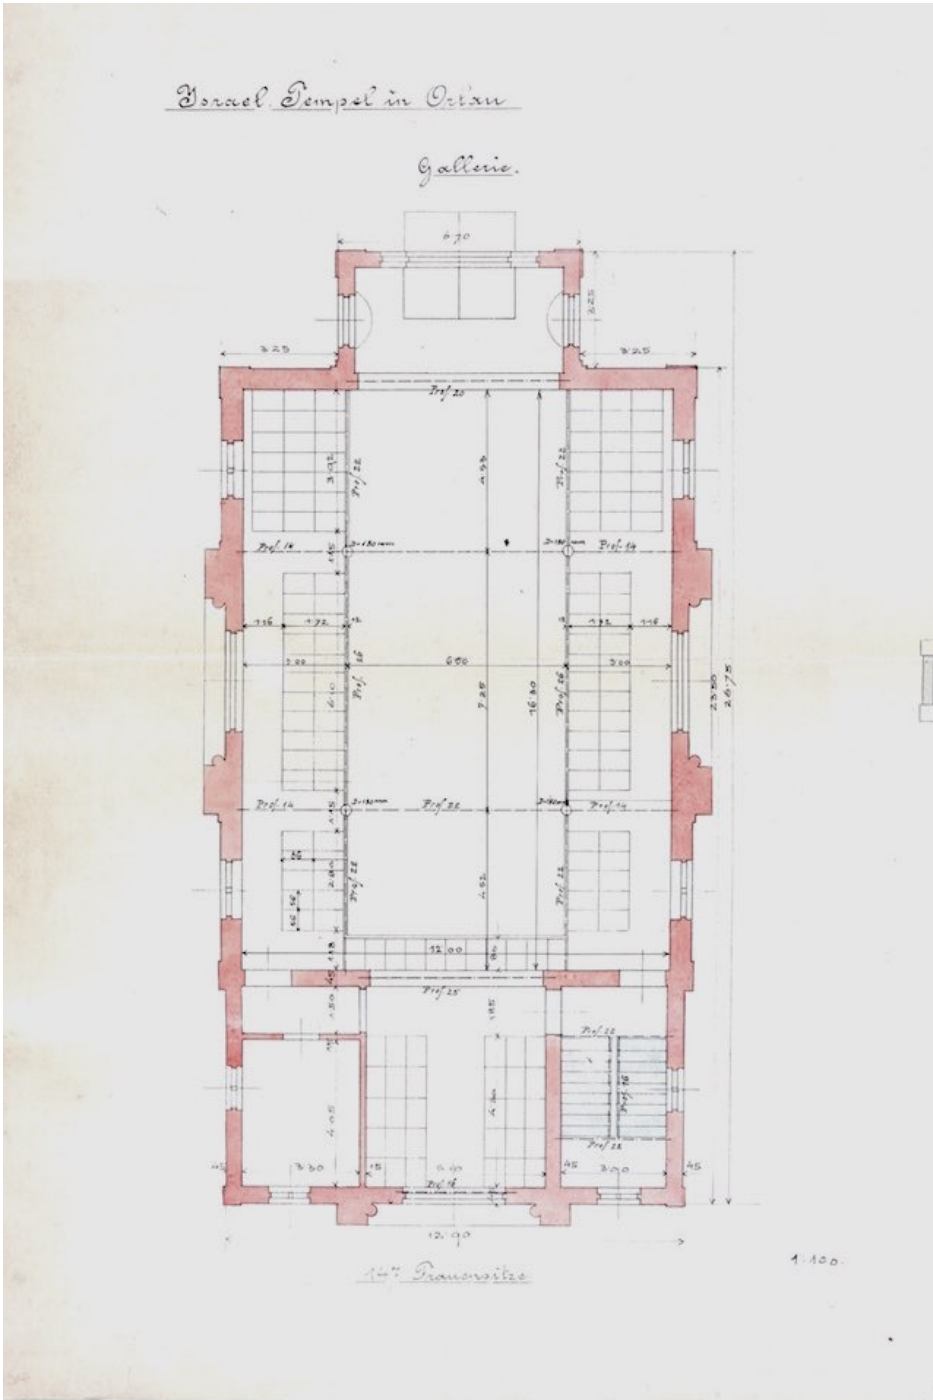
Grundriß Obergeschoß M 1:100 (rechter Teil)
